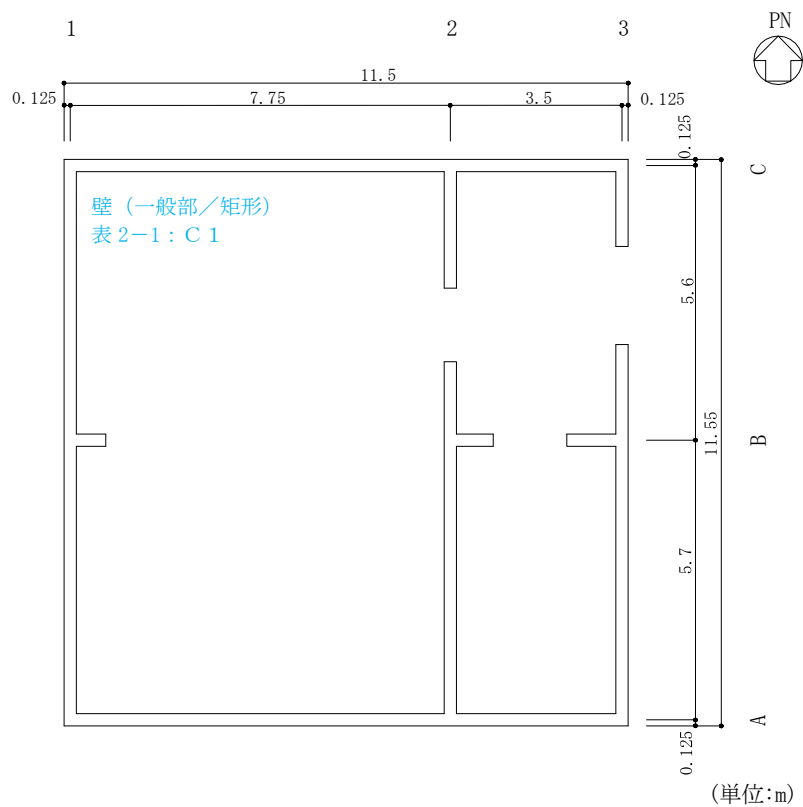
排気筒モニタ室の概略平面図 (EL 8.8m)
